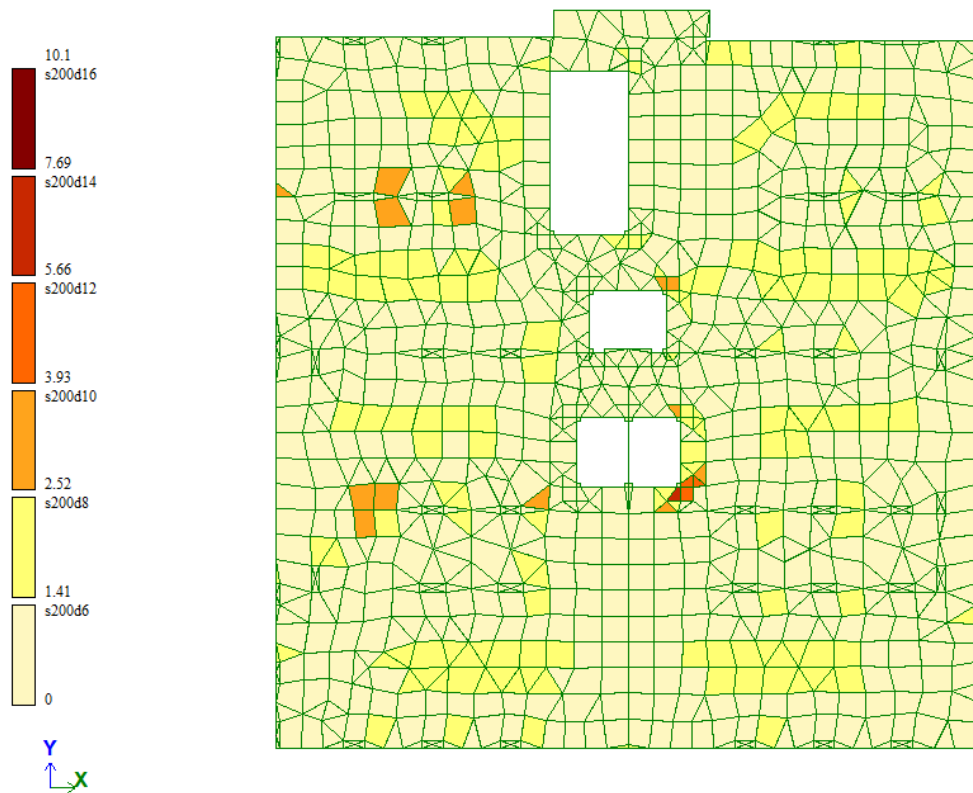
Схема армирования низа плит по оси ОУ
